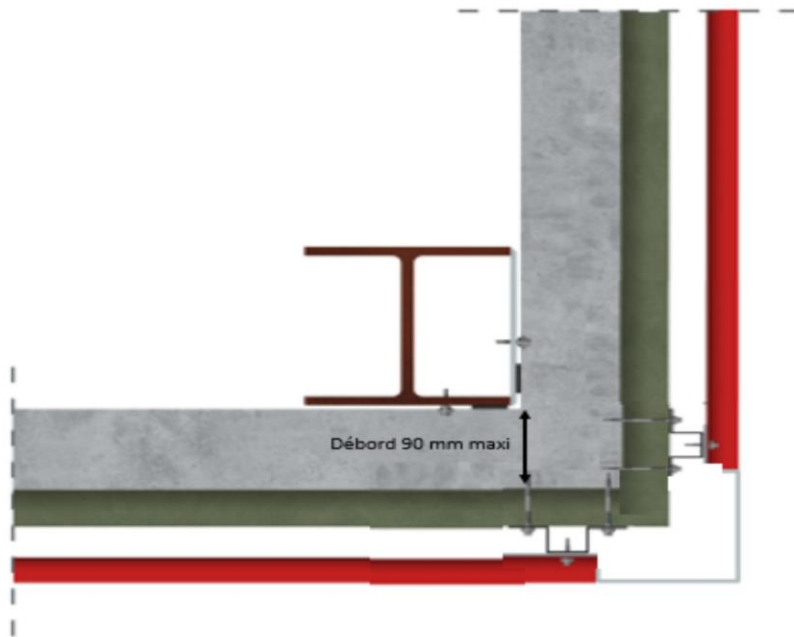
Angle sortant – Exemple de solution de bardage horizontal avec ossature secondaire
